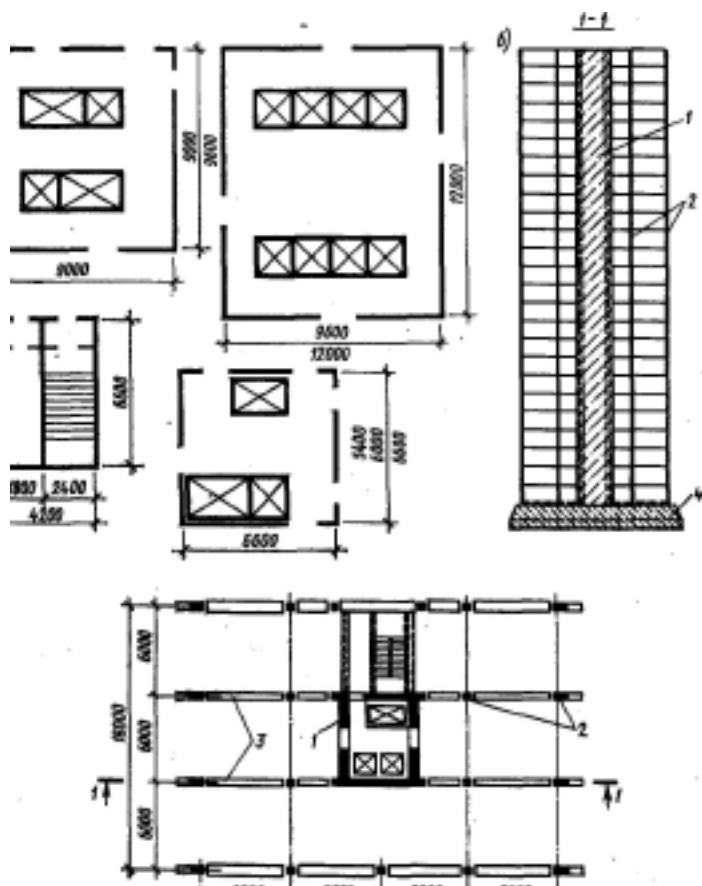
Конструктивные схемы каркасных зданий с монолитными ядрами жесткости: а — варианты компоновки ядер жесткости; б — проект 26-этажного жилого дома в Москве; 1 — монолитное ядро жесткости; 2 — колонны каркаса; 3 — ригели; 4 — фундамент
